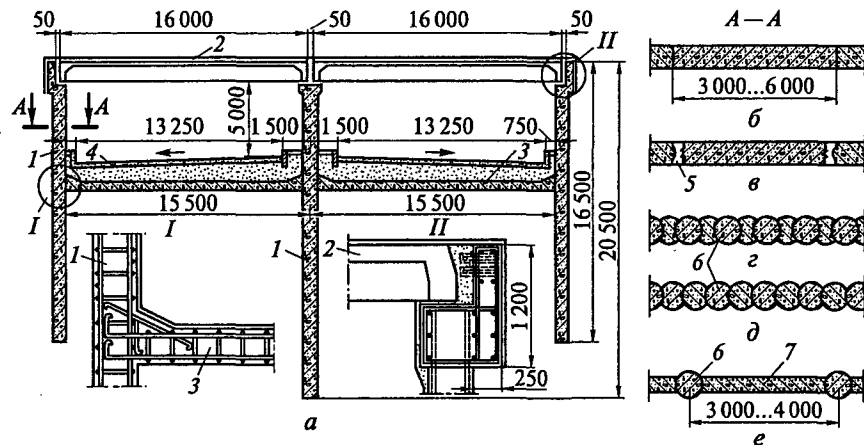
Конструкция автотранспортного тоннеля из сборного железобетона при котлованном способе работ:
